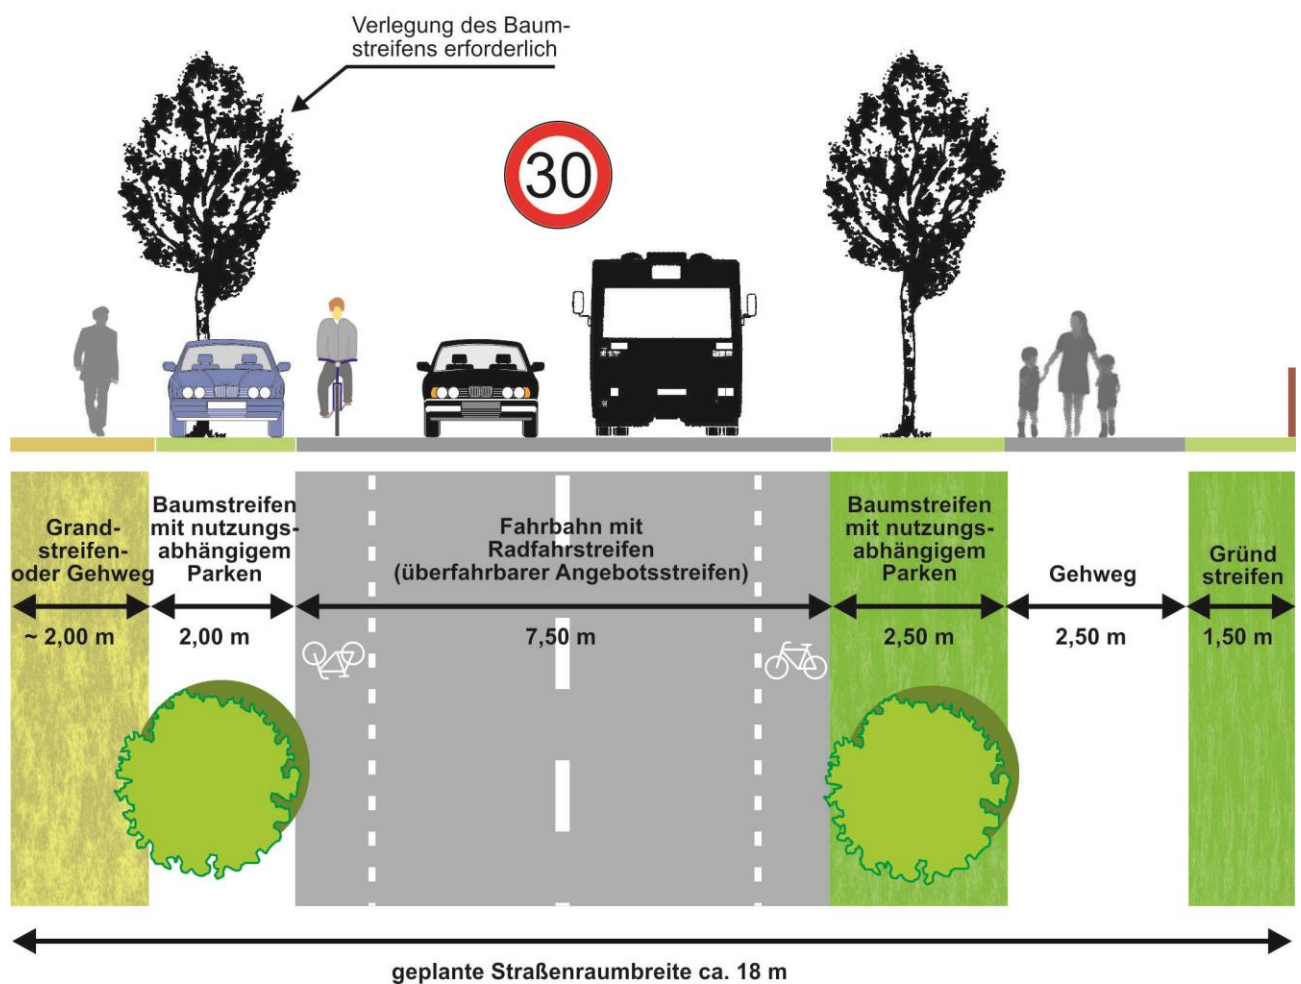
Entwurf für den Straßenraum im Abschnitt Pötenitzer Weg bis Wiekstraße
